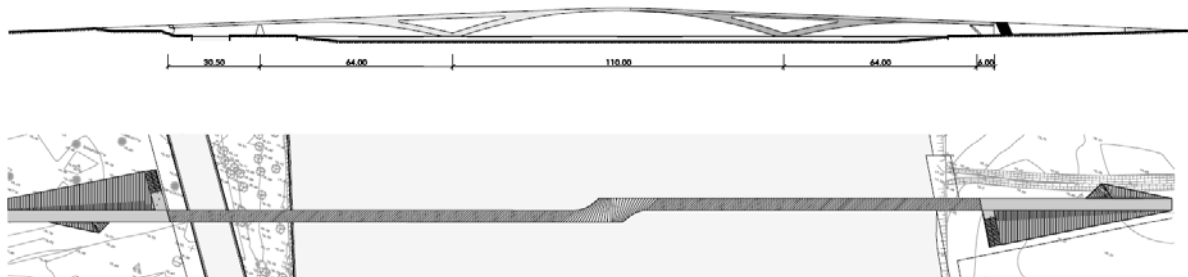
Planta e elevação da passarela Pedro e Inês [5]
